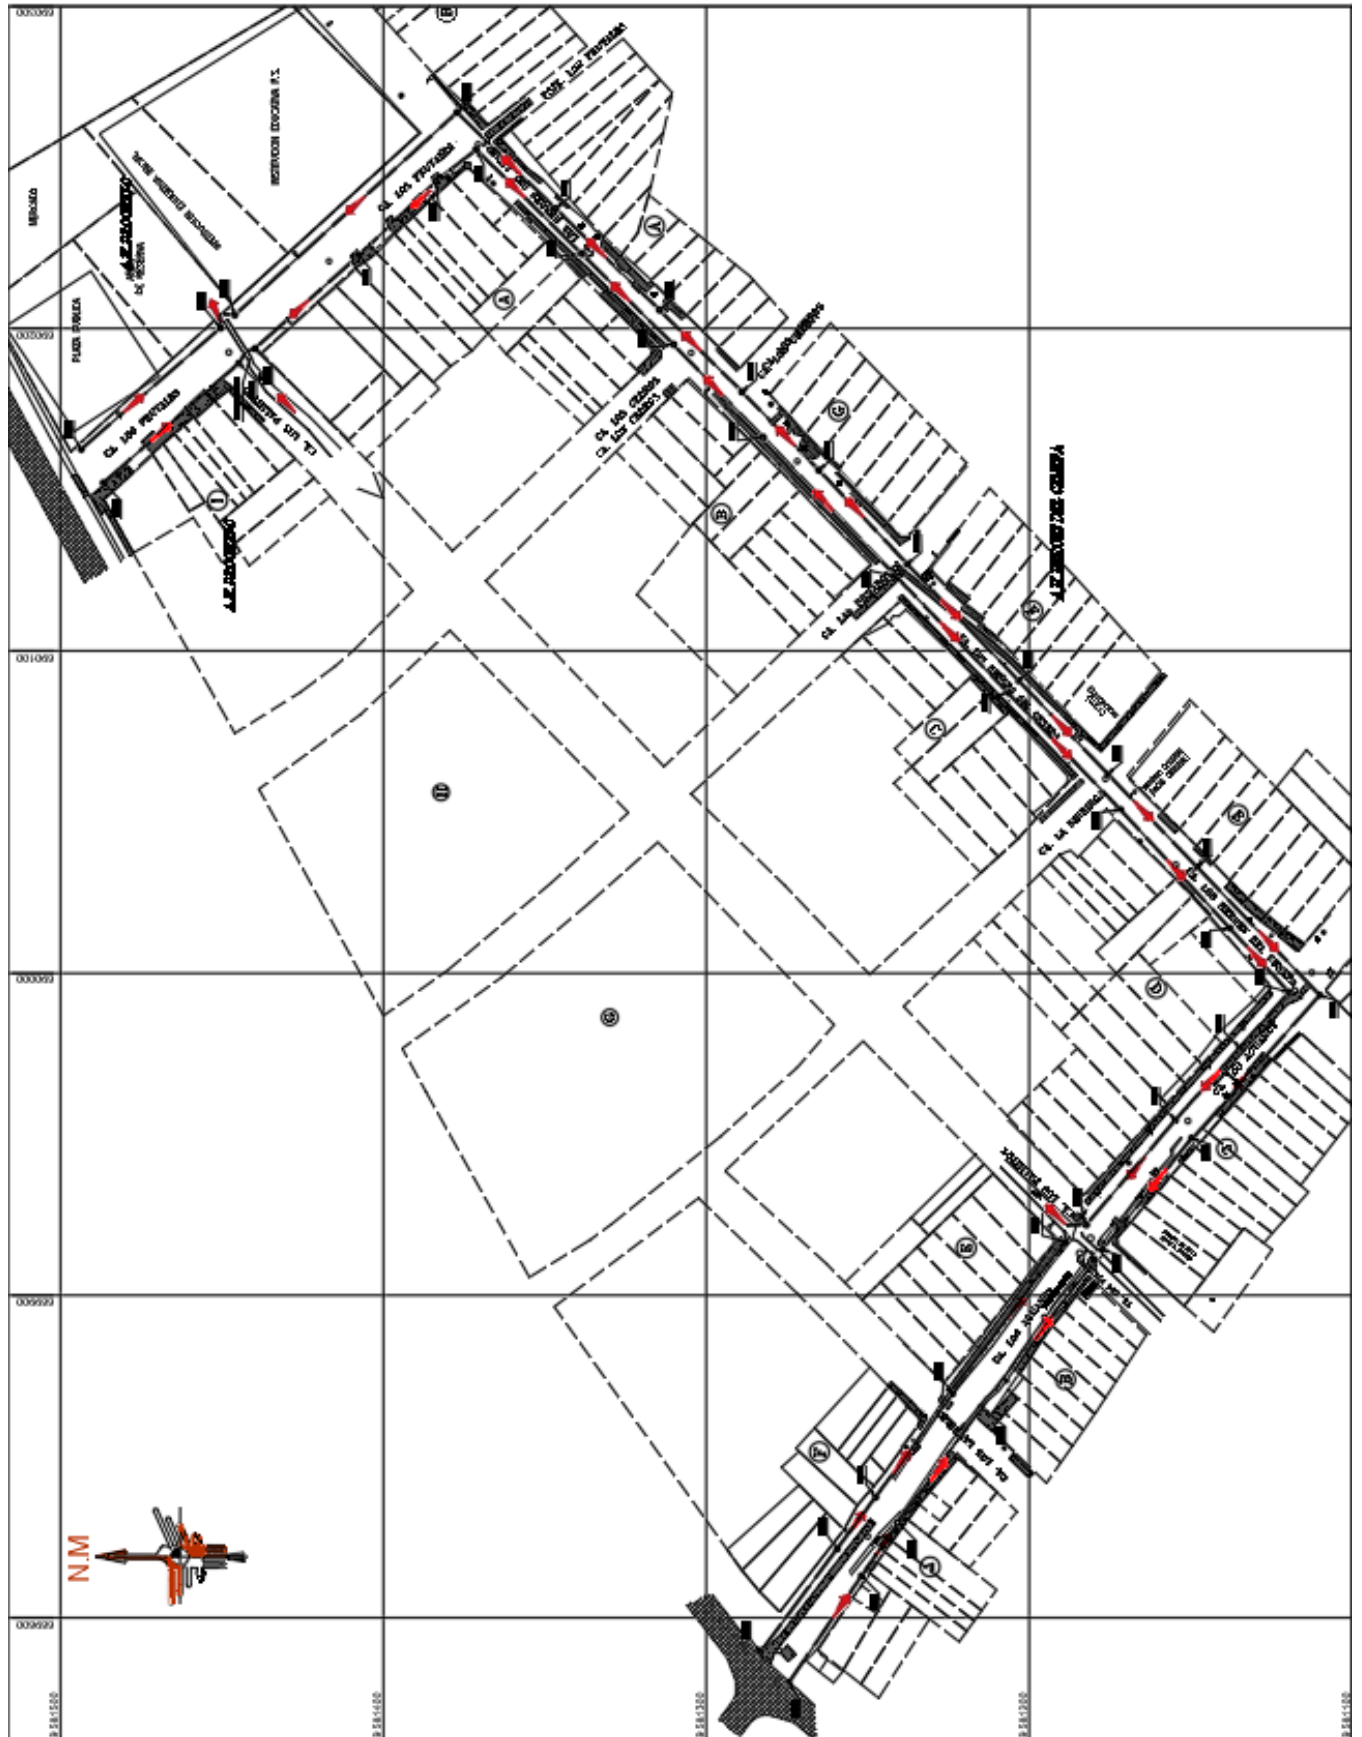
Plano de planteamiento general del proyecto. Fuente: Elaboración propia
